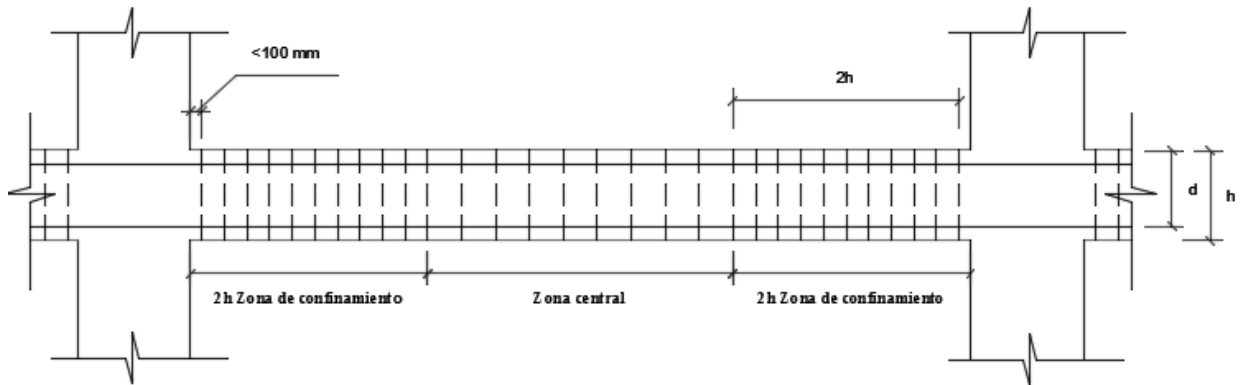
Distribución de acero de refuerzo transversal en viga. Recuperado del RNE RNE E.060 (2016).
